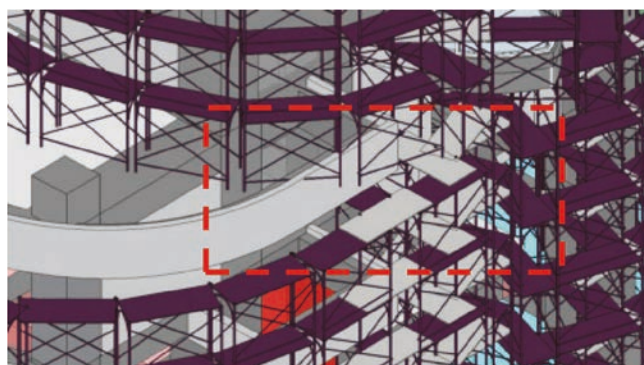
施工架施工規劃錯誤，以 BIM 檢核後適時修正前後比較圖
